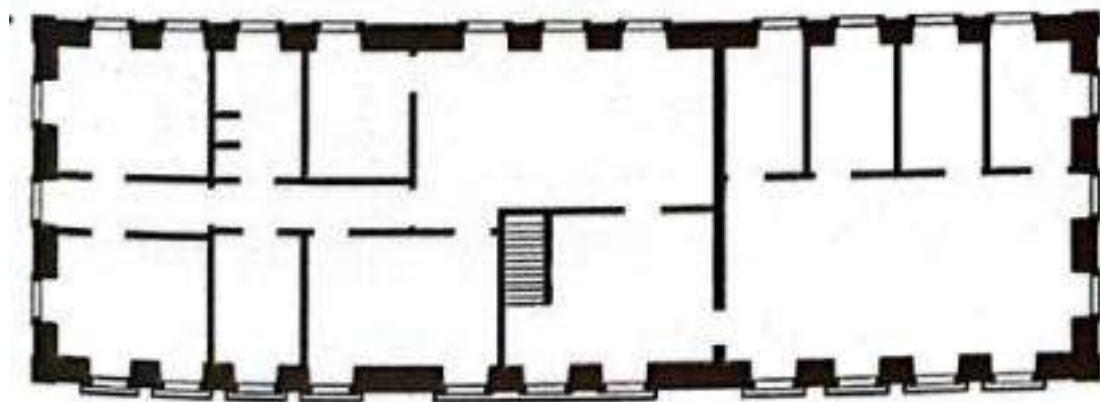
Planta do pavimento térreo do Solar Souza Leão.
